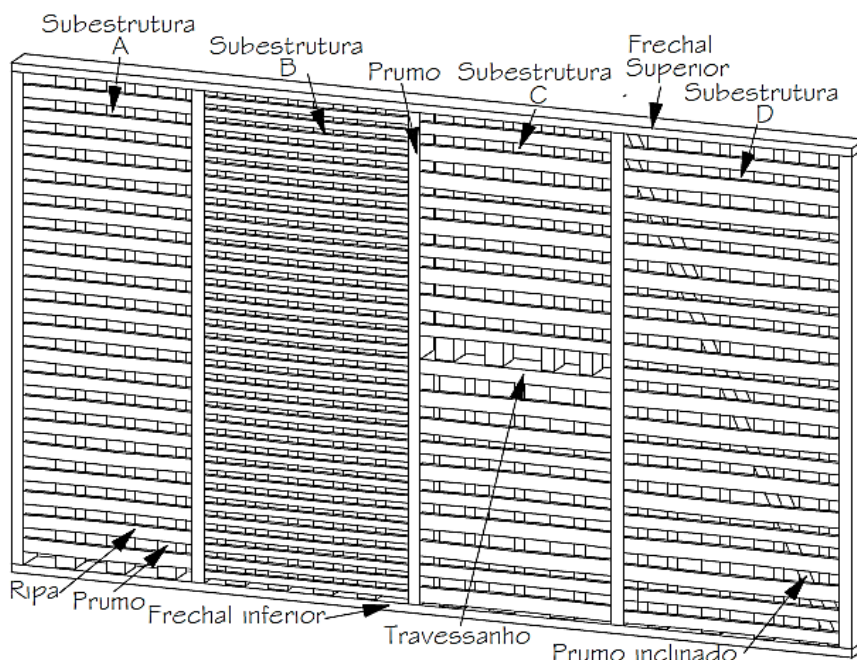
Esquema de uma parede exterior de tabique da tipologia C
